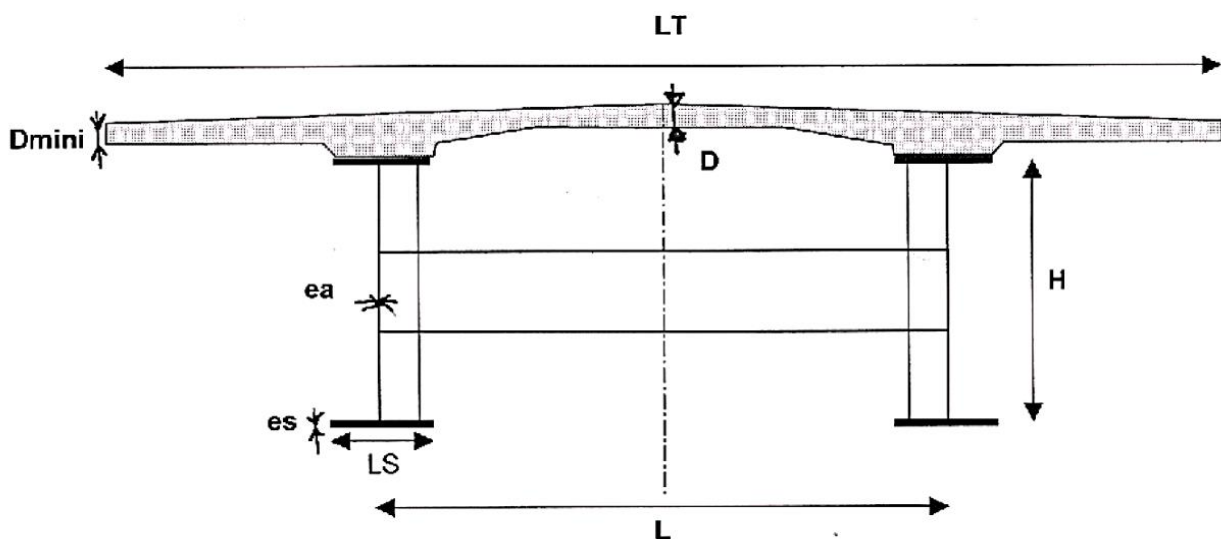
Notation des dimensions d'un pont mixte bipoutre à entretoise [14]
